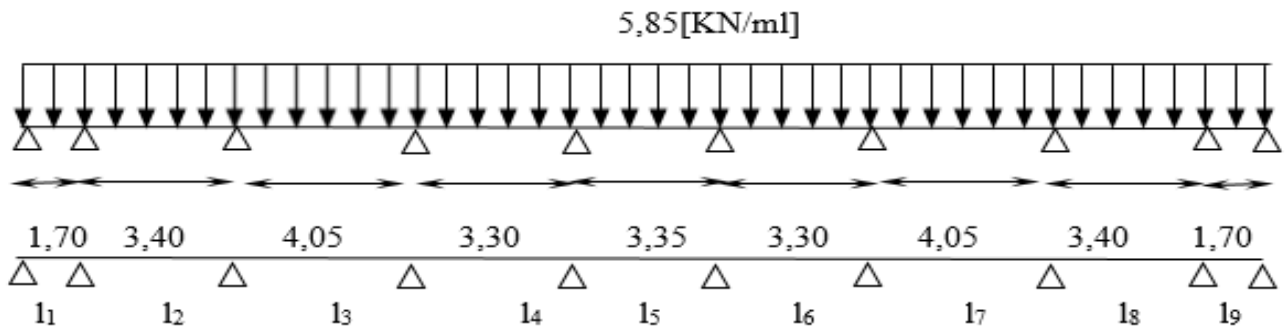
chargement du 1^{er} type de poutrelles |
